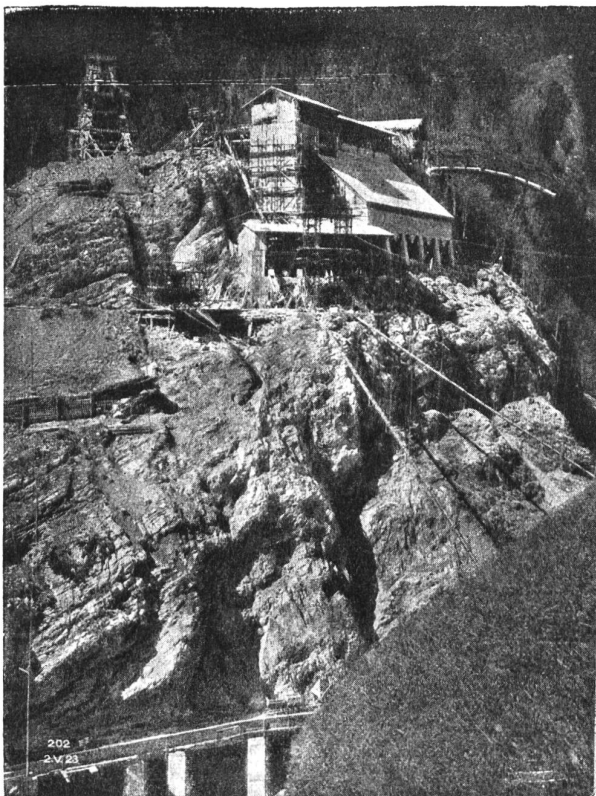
Kraftwerk Wäggitäl: Betonieranlage zum Bau der Staumauer.
